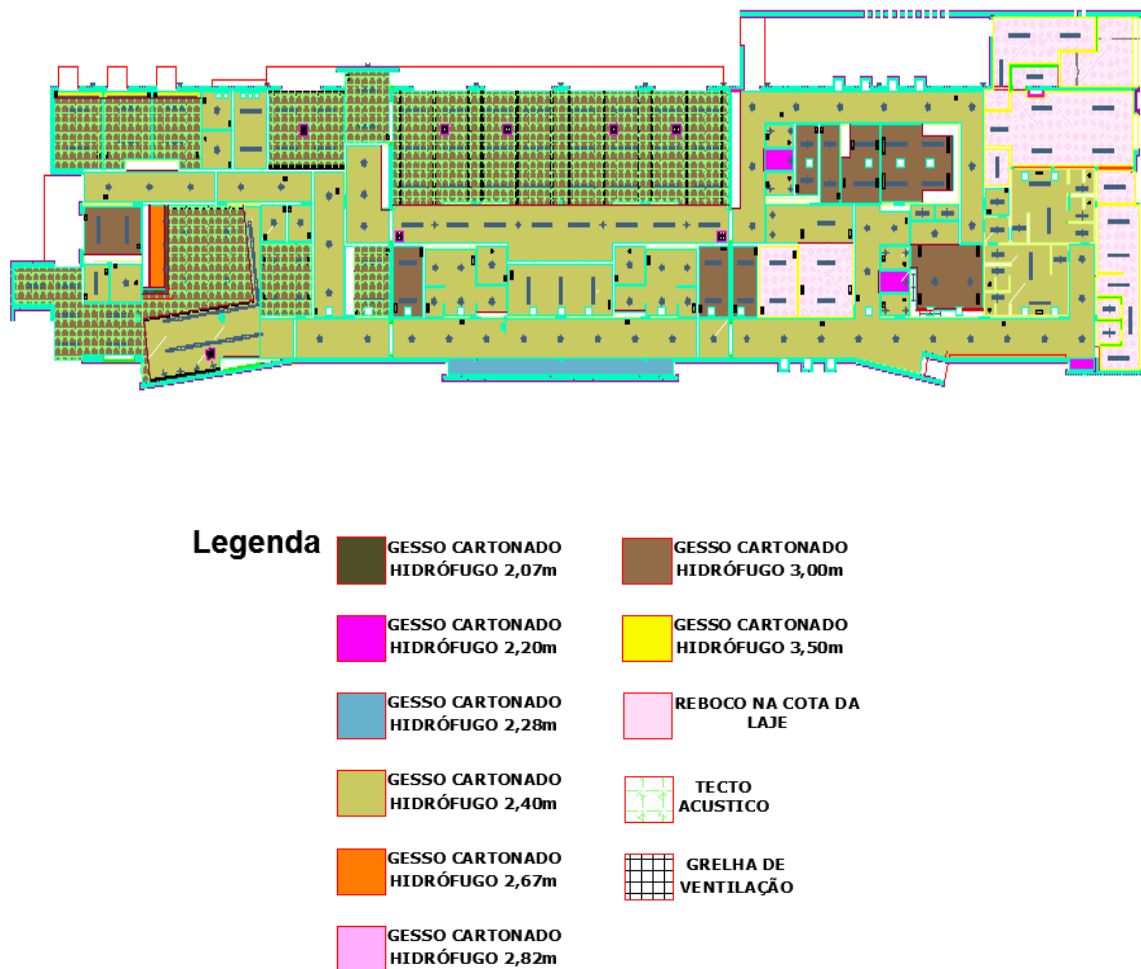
Planta de tetos (Fonte: Projeto de Arquitetura)
